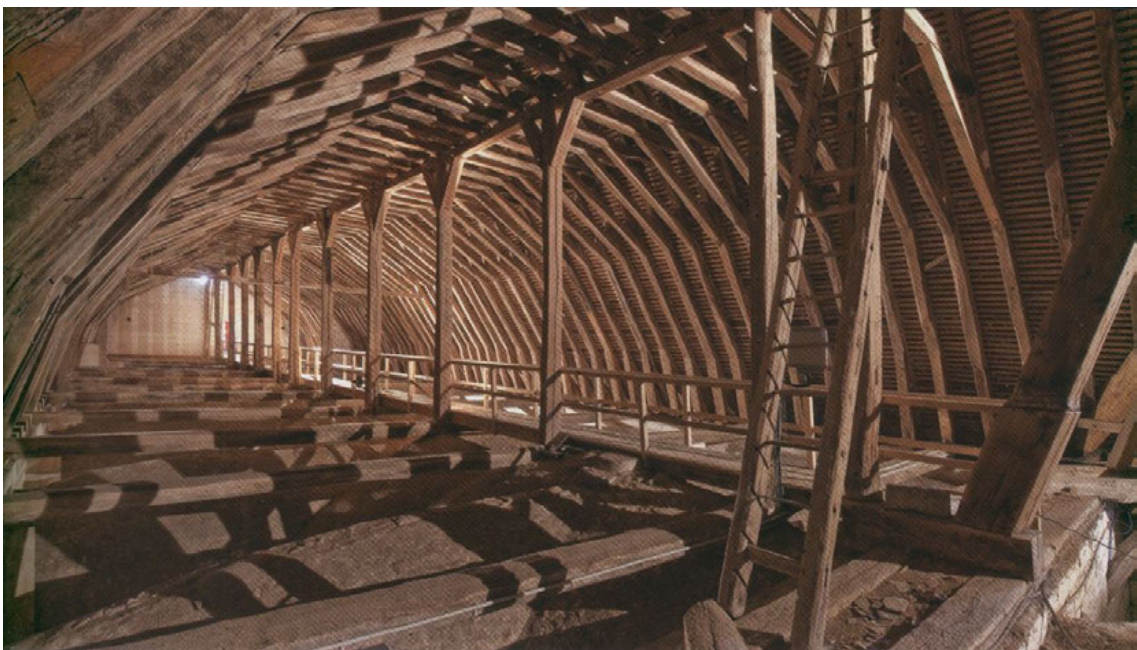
Dachstuhl des Langhauses mit Blick in Richtung Westen
